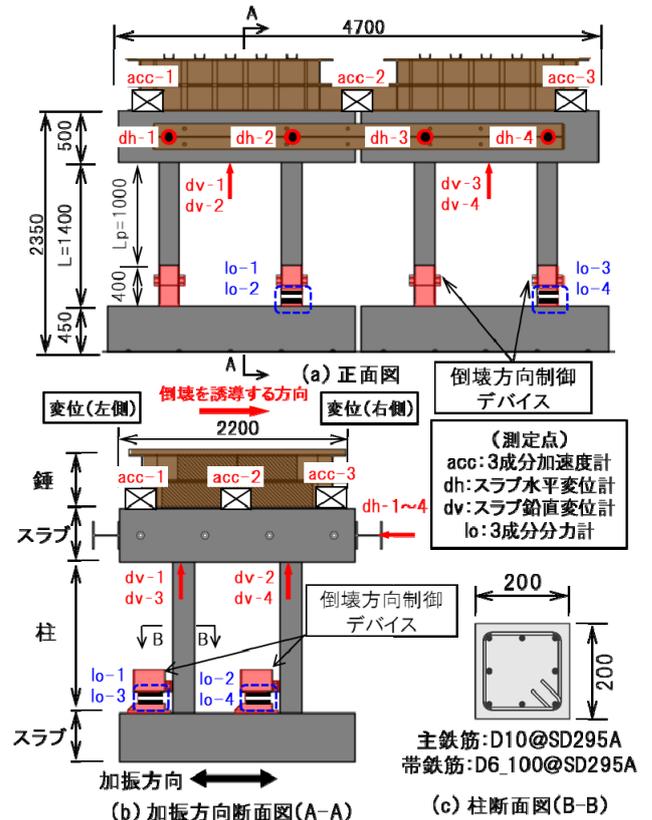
ラーメン高架橋試験体の概要 (単位:mm)
